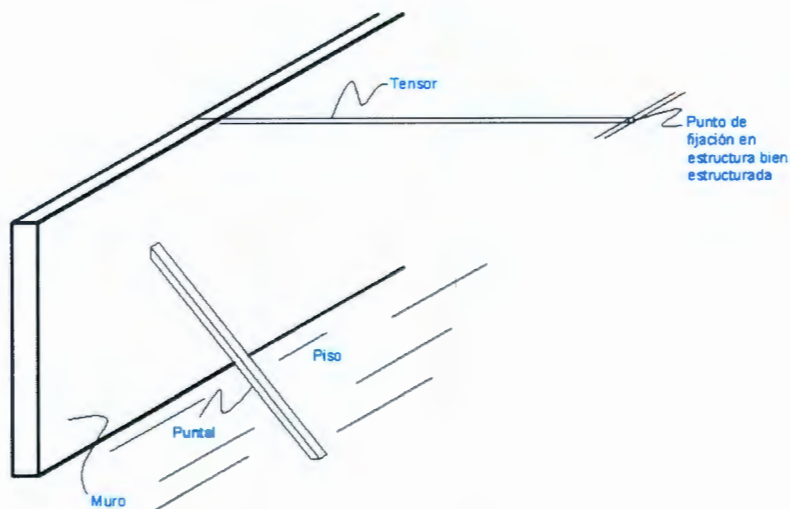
Croquis de apuntalamiento para construcciones mal estructuradas (Bardas sin muros perpendiculares ligados a ellas).
